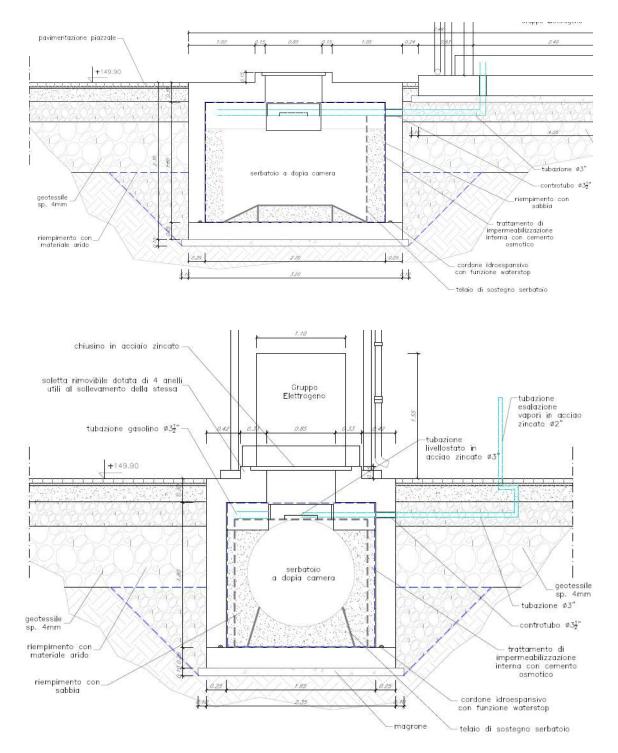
Vasca di serbatoio di GA1 PP/ACC Boschetto - Sezione longitudinale e trasversale
